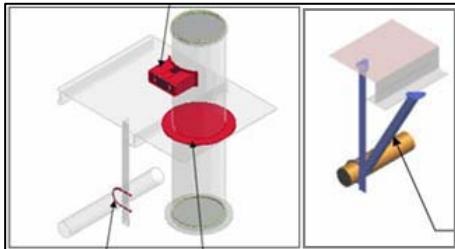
UBolt 형 Support, Penetration Piece, Gas Pipe 용 Support, Y Shape Support
